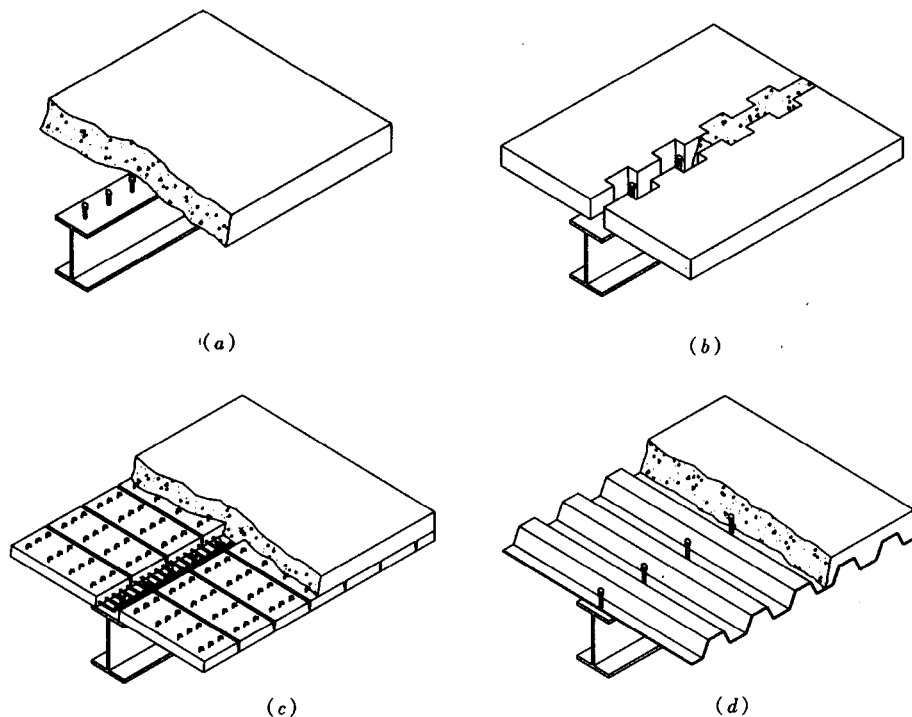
不同混凝土翼板的钢-混凝土组合梁截面形式
